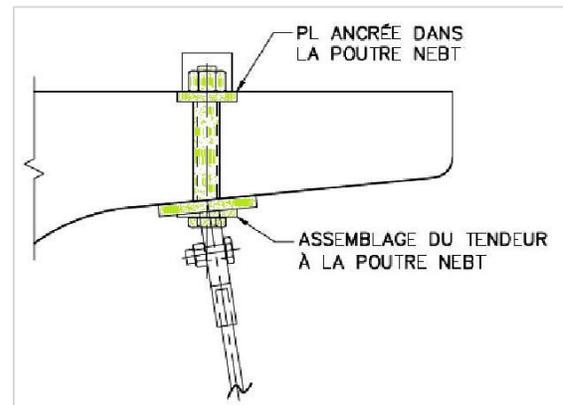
Détail de l’ancrage encastré pour équipements suspendus installé dans la semelle supérieure d’une poutre NEBT
